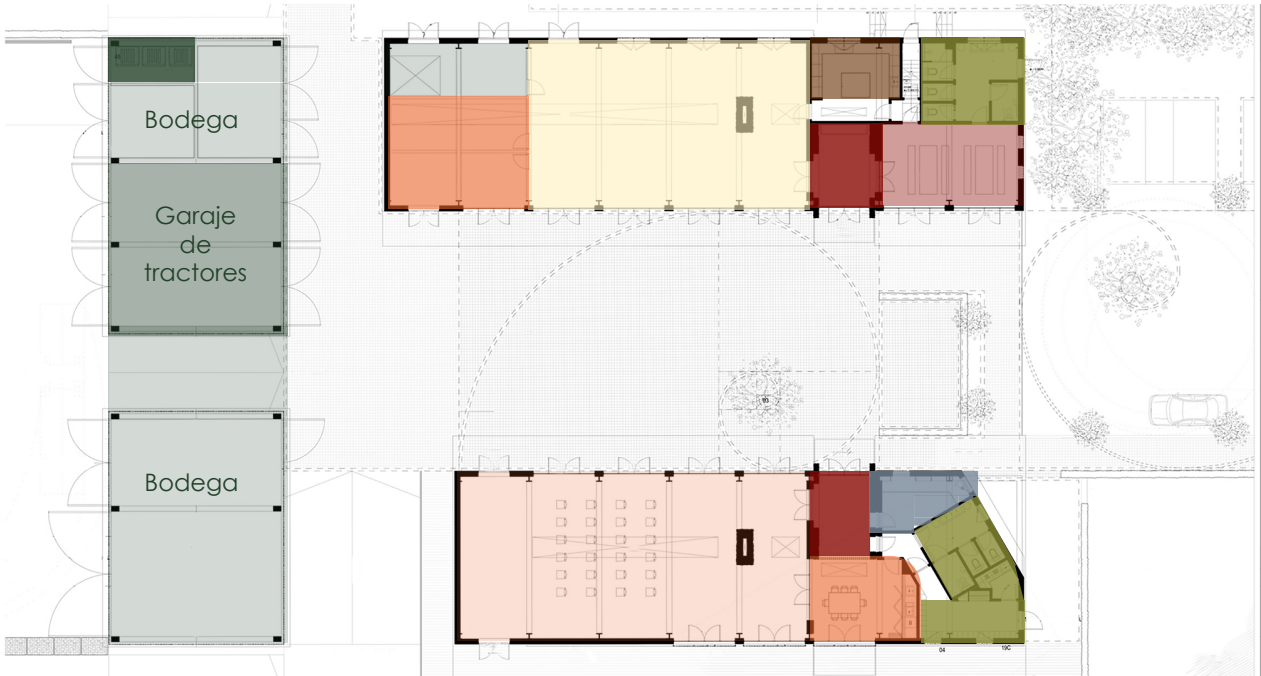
Planta arquitectónica con zonificación espquemática. Elaboracion propia, 2025
